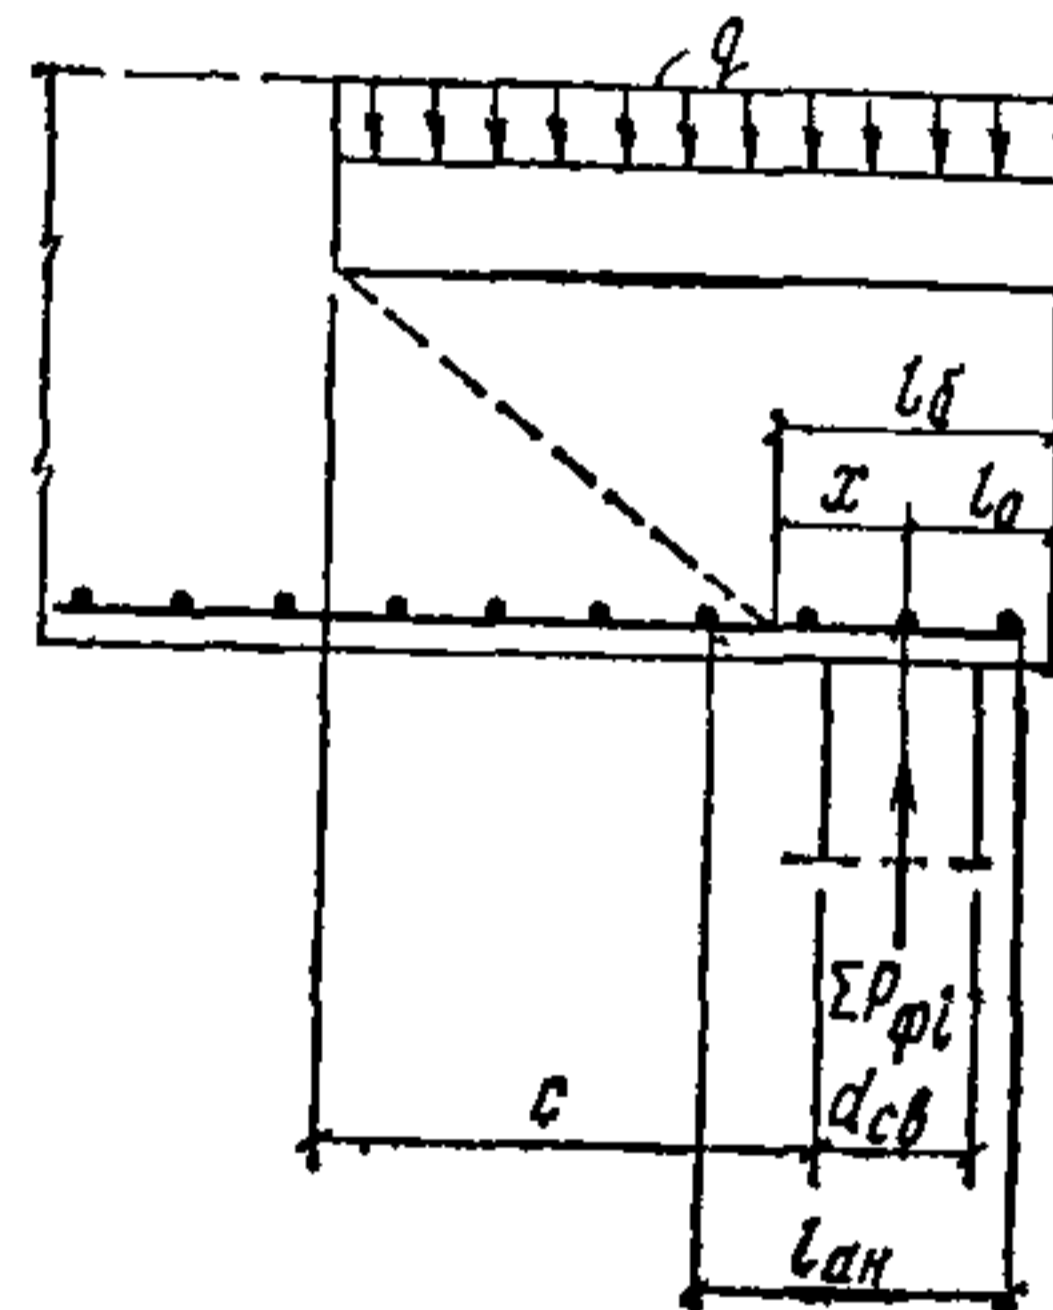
Расчетная схема при проверке рабочей арматуры в плите ростверка на прочность при изгибе по наклонным сечениям
